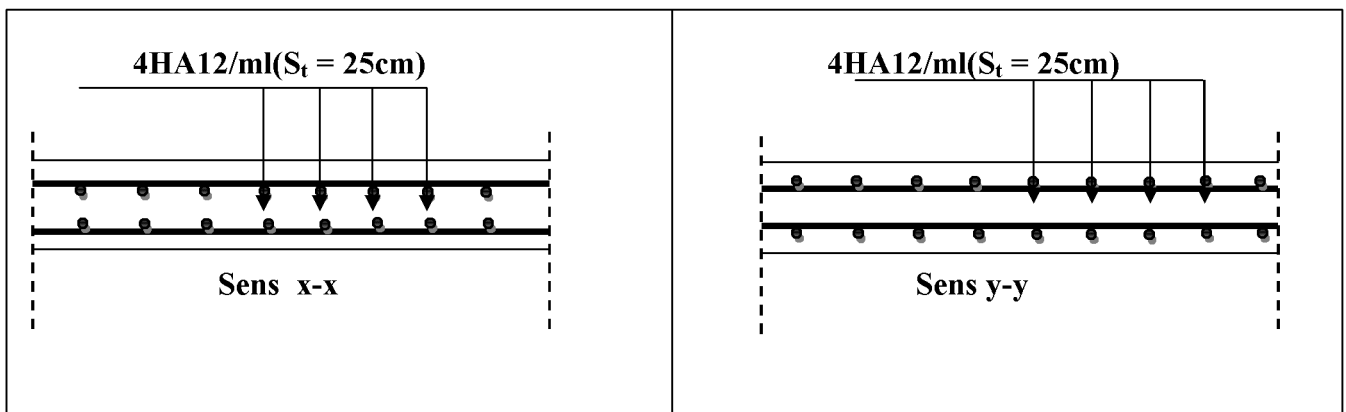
Ferrailage de la dalle pleine de la salle machine en appuis.
